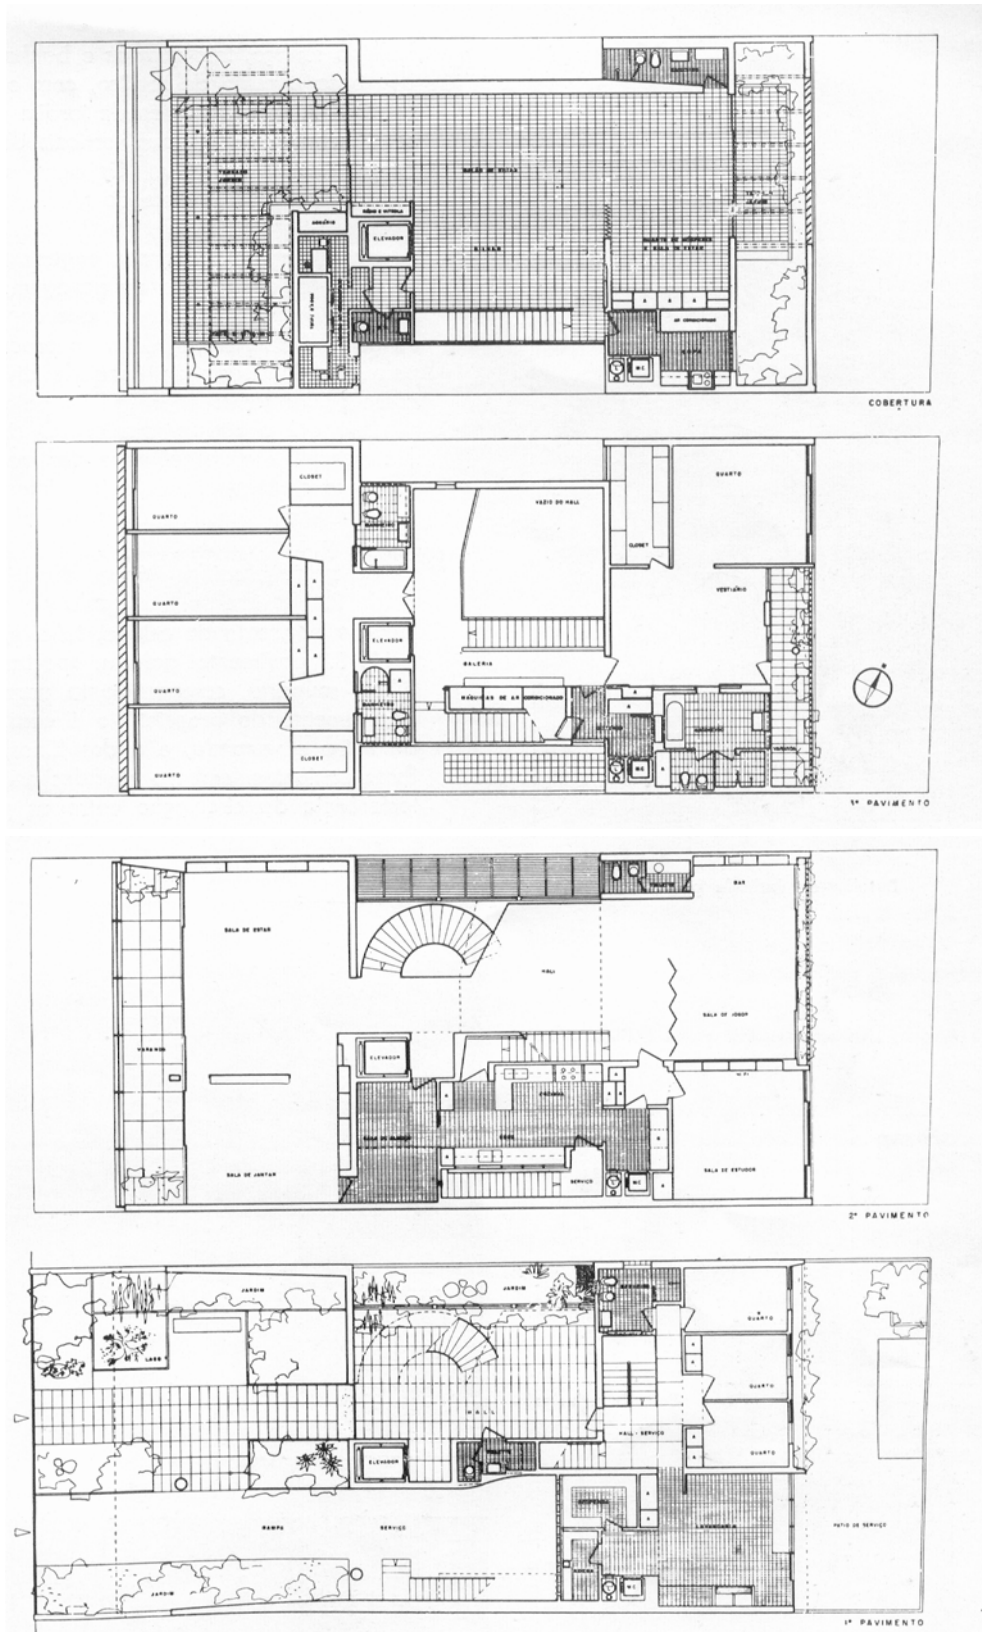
Plantas: Subsolo; 1º Pavimento; 2º Pavimento e 3º Pavimento.
